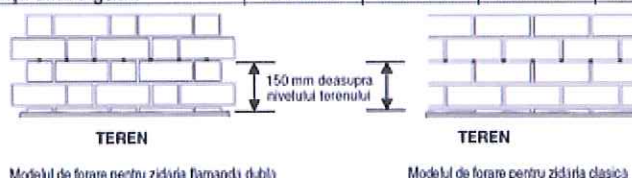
Corespondența dintre adâncimea găurilor și grosimea peretelui. Poziție forare găuri
